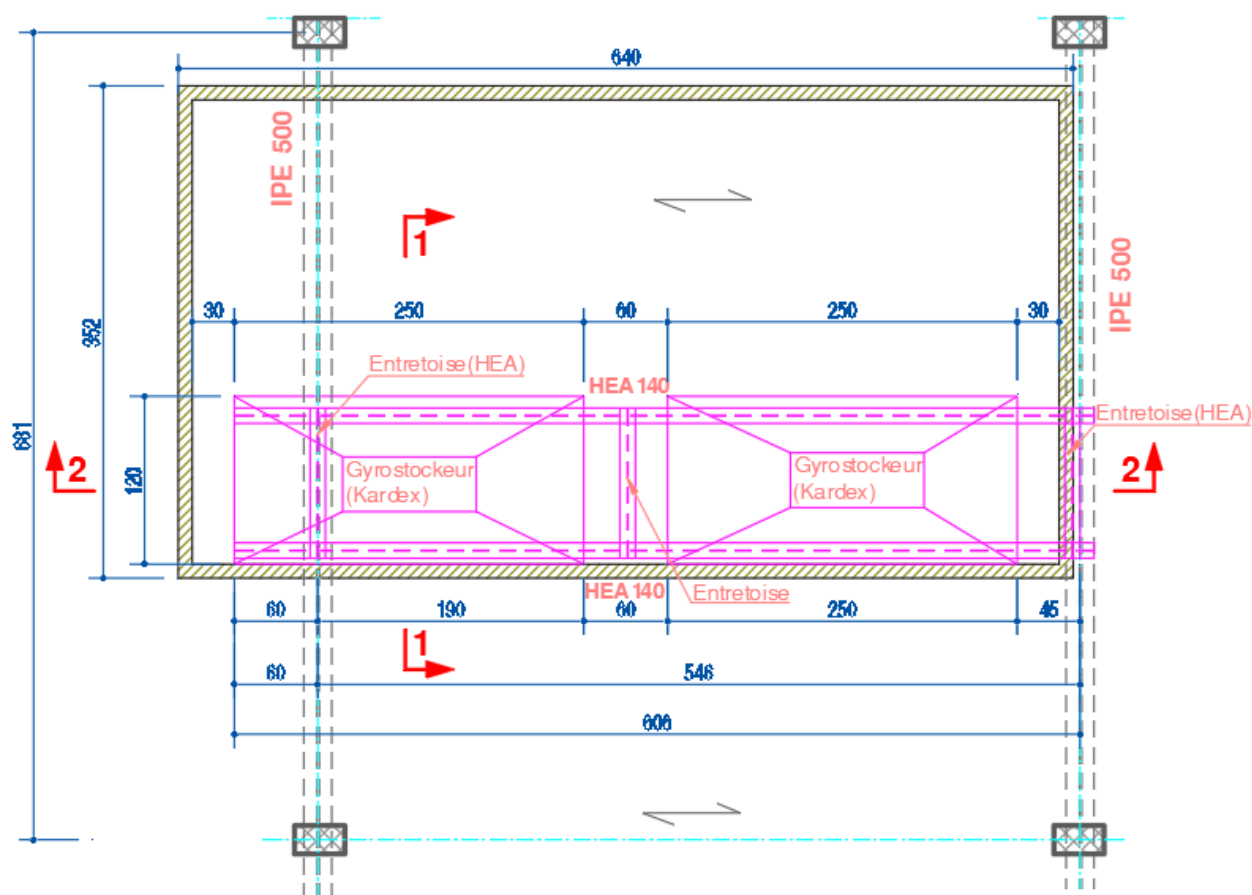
Vue en plan (plancher bas de la chambre froide)
